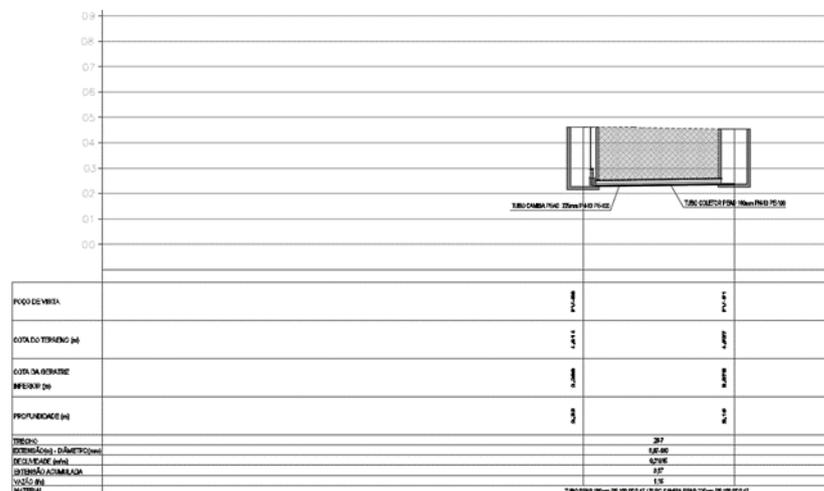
Perfil longitudinal da travessia SB-T20 PV-51 AO PV-56
